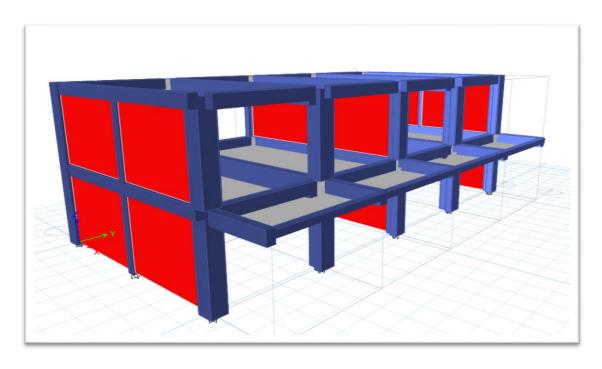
Modelado de las columnas "T" y "L"- vista en 3D
